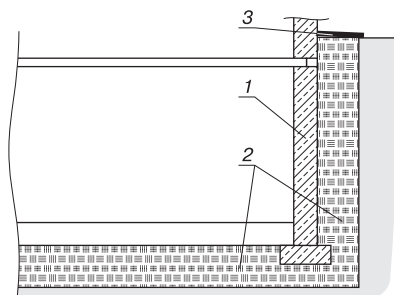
Схема гидроизоляции подземного сооружения: 1 — бетонная обделка; 2 — гидроизоляционный экран; 3 — бетонная или растворная отмостка
